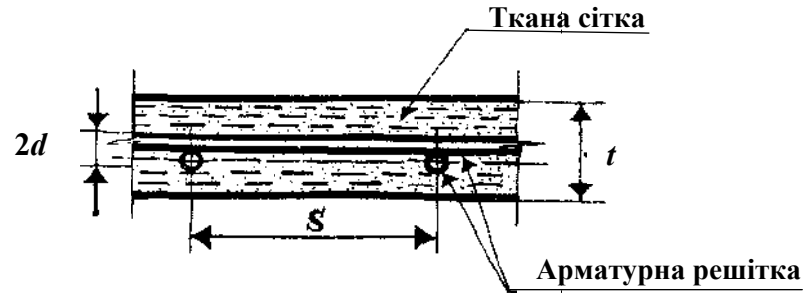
Переріз армоцементного елемента, армованого пакетом тканих сіток із прокладкою усередині арматурних решіток
